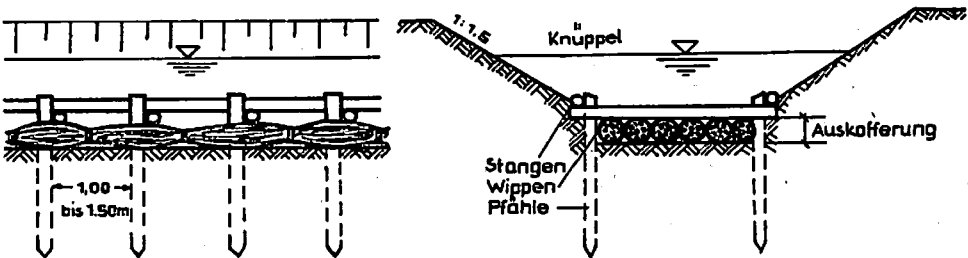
Sohlenbefestigung durch Faschinen (Wippen)
